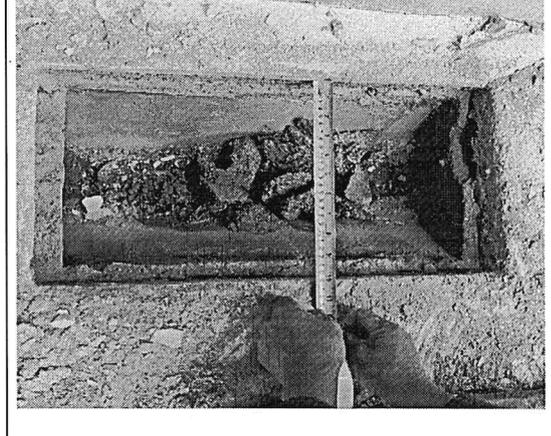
Detalle de la tapa del drenaje pluvial, de acuerdo al plano, la asa debería ser de fierro corrugado de 3/8".
